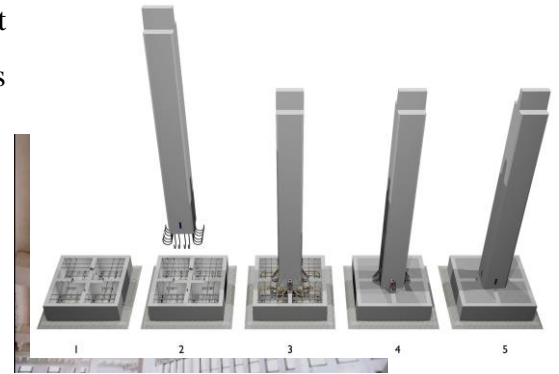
Poteaux préfabriqués. (monachinotechnology s.d.)
